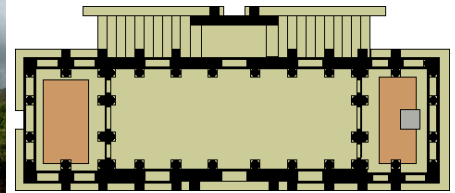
Planta de Santa María del Naranco, 842, Oviedo. Trabajo de José-Manuel Benito.
